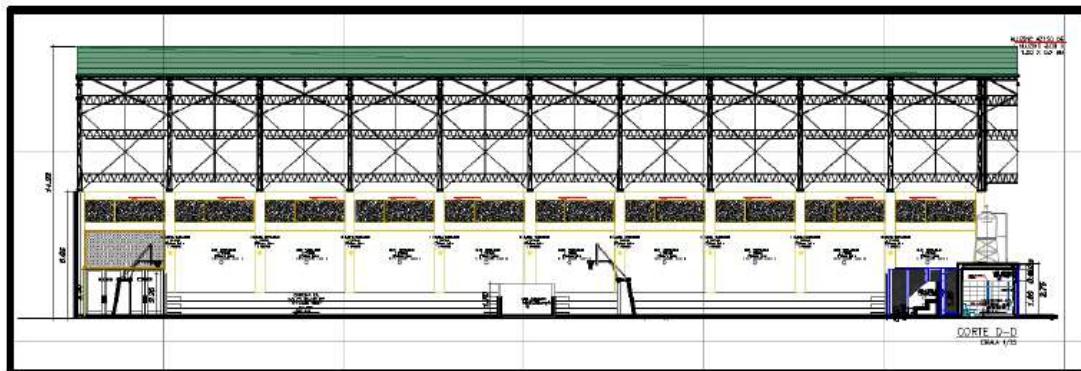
Corte de la propuesta arquitectónica (C-C)
